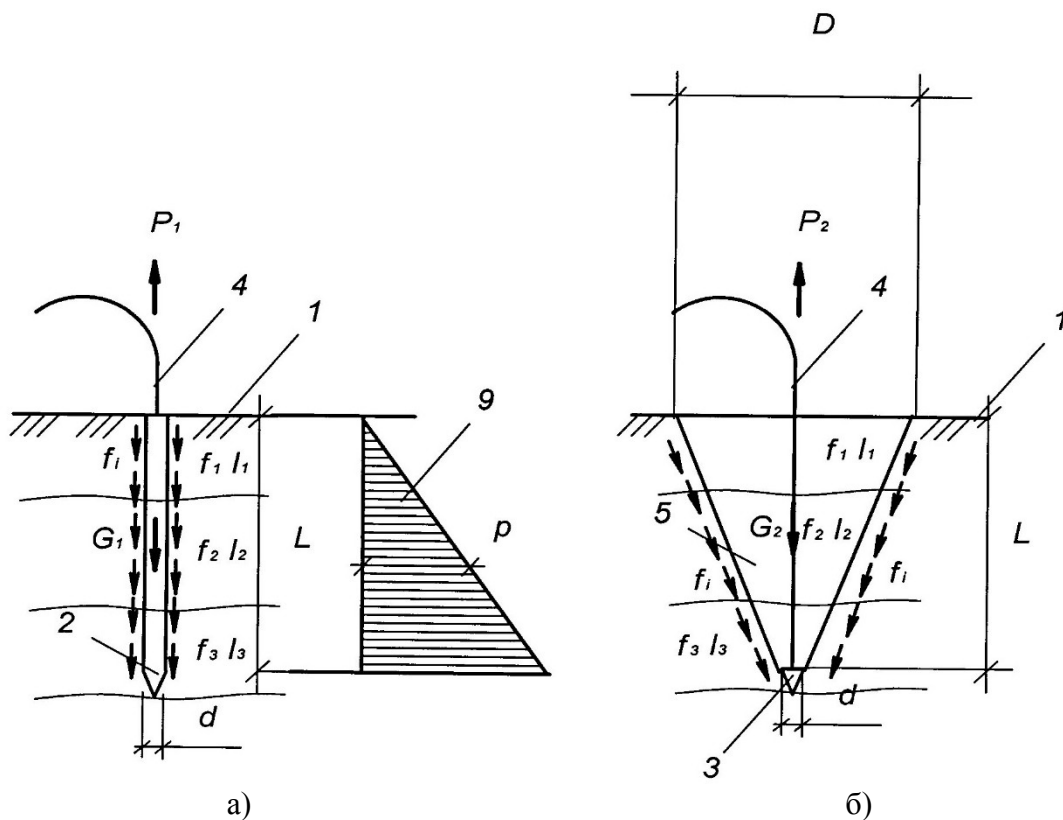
хемы к расчету проволочных анкеров: P_1 – сила выдергивания свайного анкера; d – диаметр свайного анкера; f_1, f_2, f_3 – удельное слоев грунта; l_1, l_2, l_3 – мощность слоев грунта; P_2 – сила выдергивания из грунта проволочного анкера; G_1 – вес проволочного анкера; L – глубина заглубления проволочного анкера; G_2 – вес поднимаемого грунта; D – диаметр верхнего основания; а – схема к расчету обычного анкера; б – схема к расчету проволочного анкера; 1 – поверхность земли; 2 – свайный анкер; 3 – конусный наконечник; 4 – трос; 5 – подъемный пазух.
